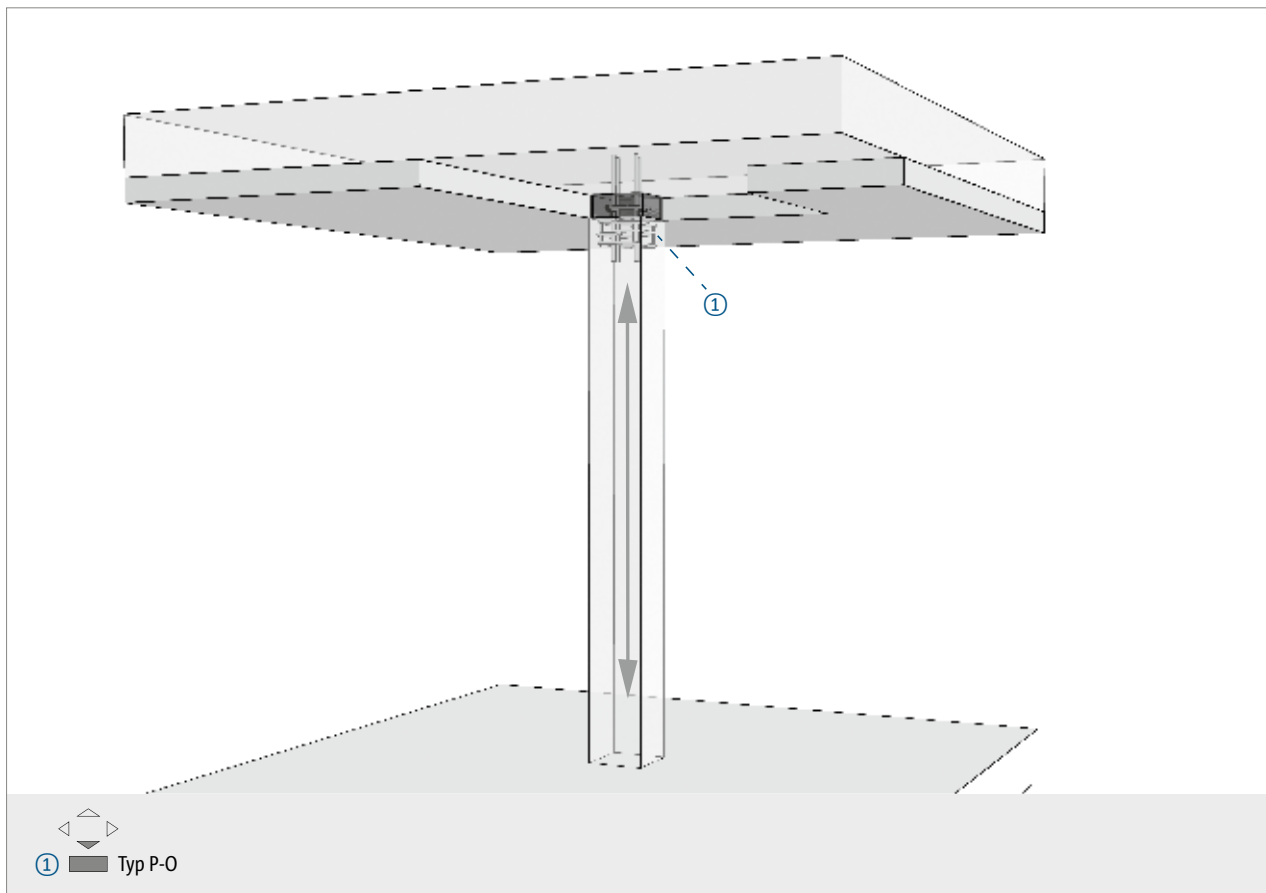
Stützenanschluss bei Unterdeckendämmung (gilt auch für Typ P-U)
